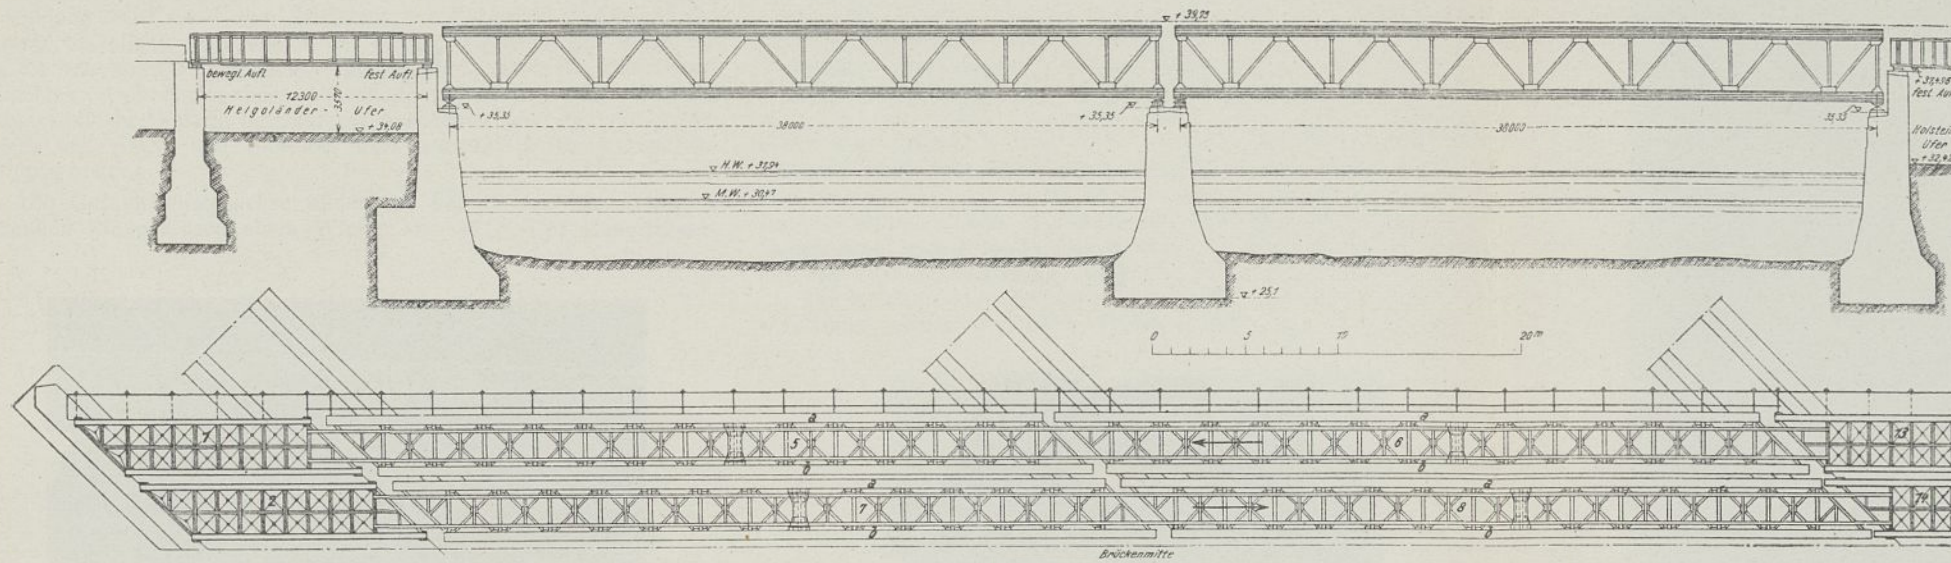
Ansicht und Grundriß (halbe Breite) des Bauwerks.
